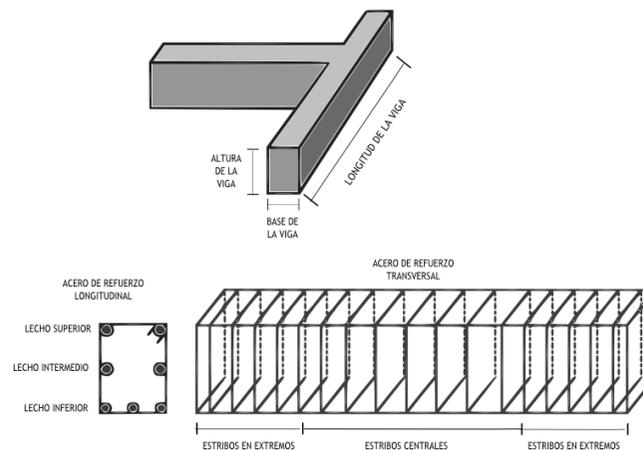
Ejemplo de armadura en viga de hormigón armado.
